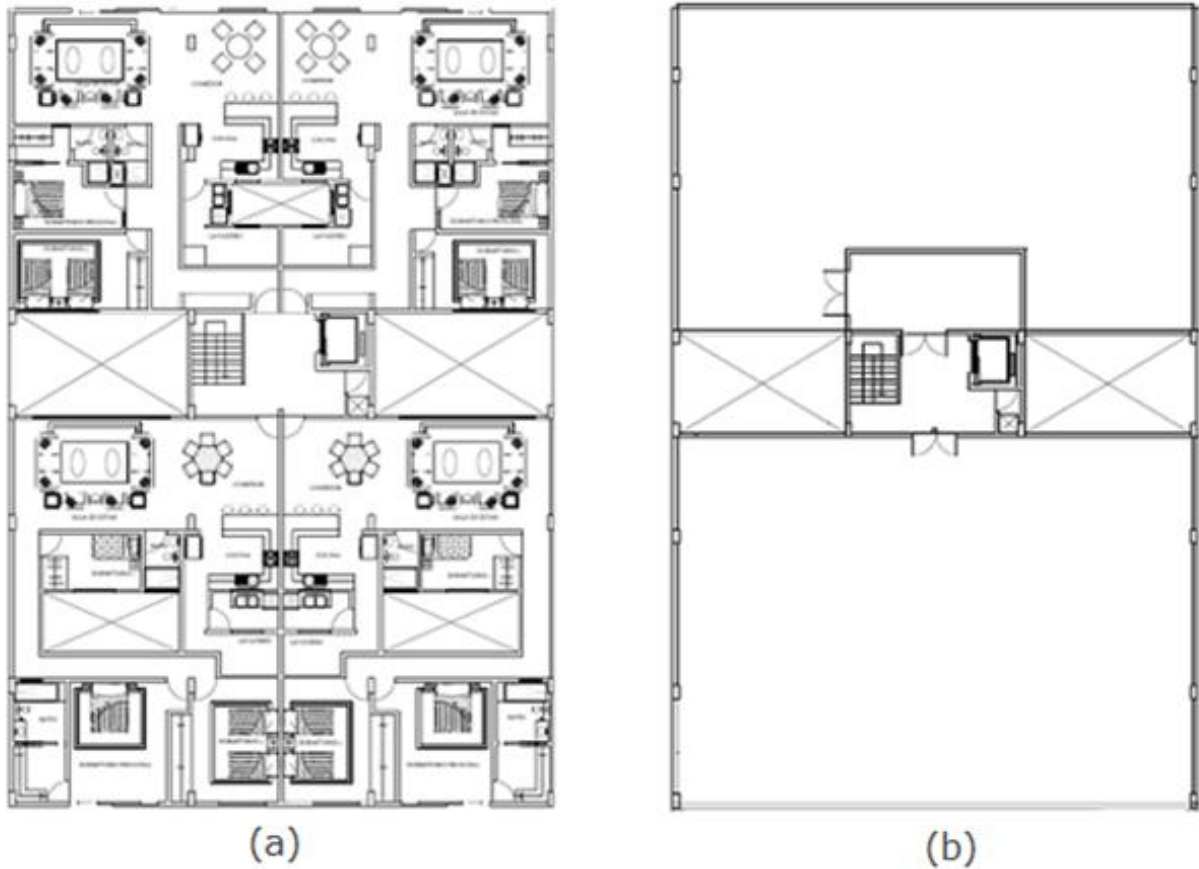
(a) Planta tipo del edificio (b) Planta de la cubierta superior
